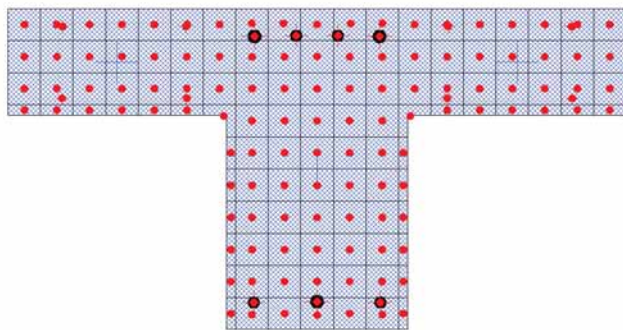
Divizare secțiune transversală în fibre longitudinale, modele structurale SAP2000 [75]
